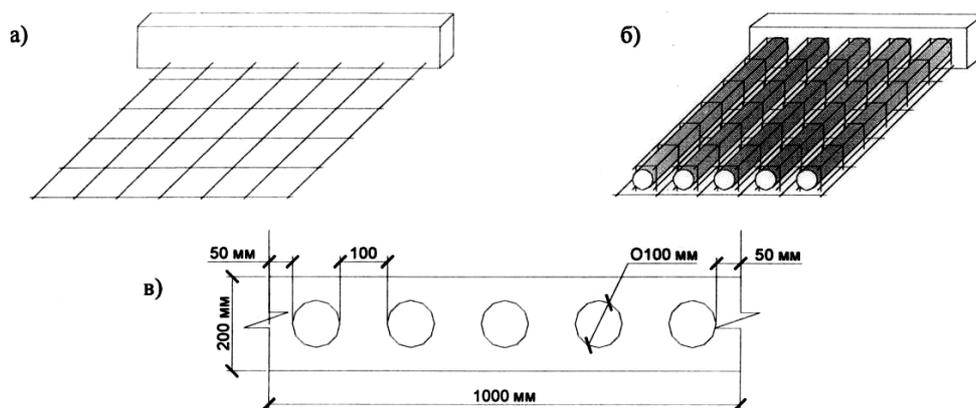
Виды монолитных железобетонных плит перекрытия, принятых для сравнения:
